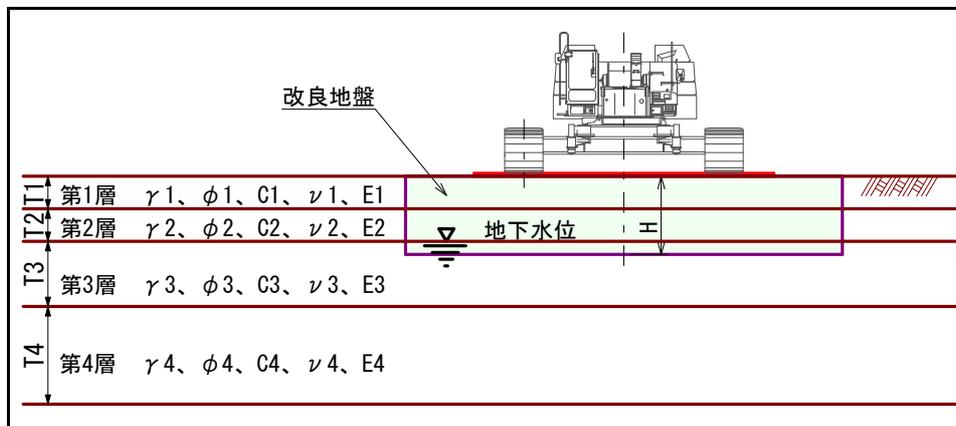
地層断面図(本図は模式図なので実際の構成とは異なる)
